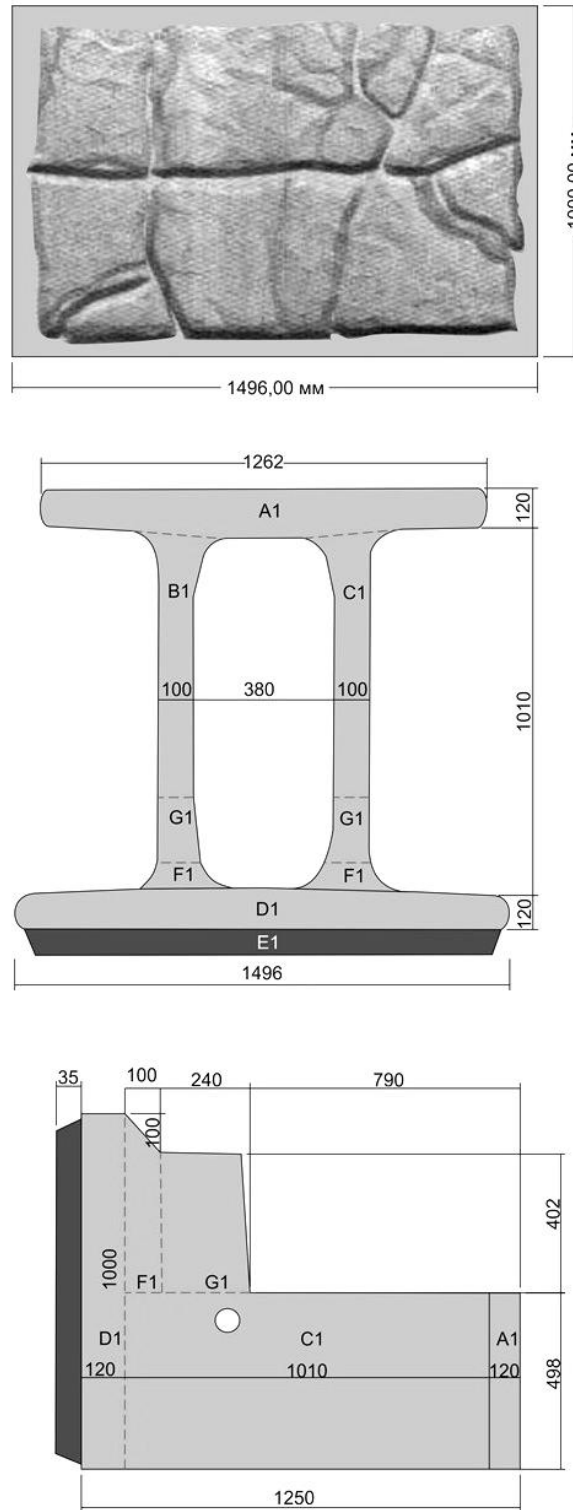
Блок конструктивный железобетонный КБП 100/150
